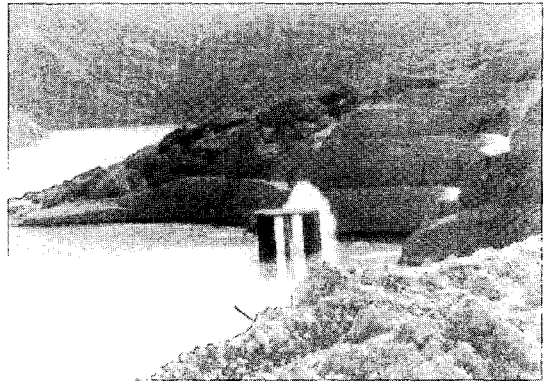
담수시 DTR Intake Tower를 통해 분수처럼 물이 뿜어져 나오는 모습
